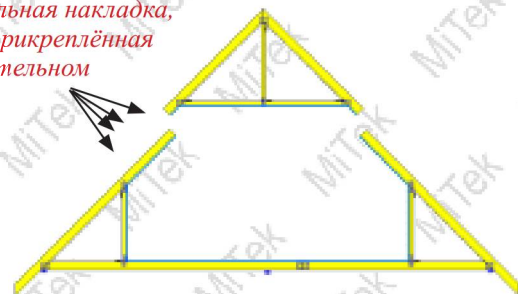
б) свободный пролет между мауэрлатами и в результате междуэтажное перекрытие подвешено от стропил, которые в свою очередь являются относительно тяжелыми и часто столь же тяжелы, как балки междуэтажного перекрытия. Связанная форма комплекта обычно отличается от типа 1, для того чтобы облегчить монтаж и гарантировать, что более важные соединения сделаны
